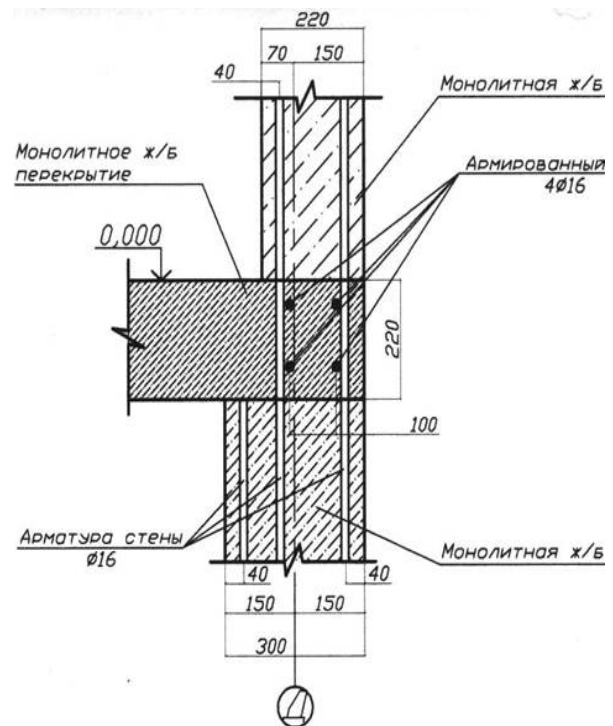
Сопряжение монолитного перекрытия со стеной
